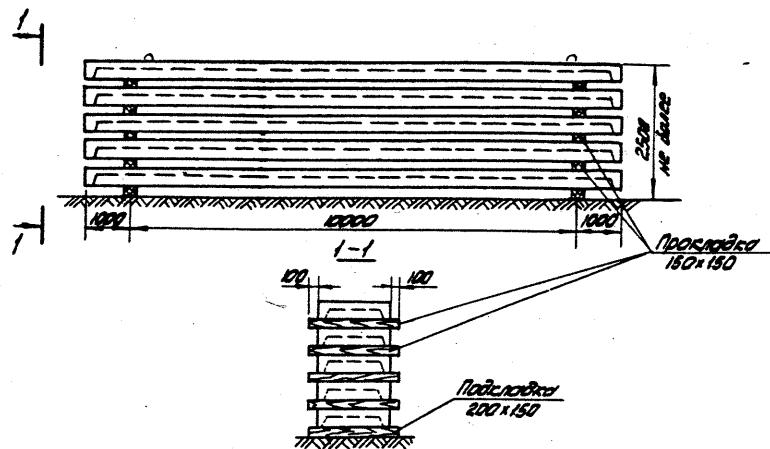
Складирование ребристых плит перекрытий типа ПРС-12
